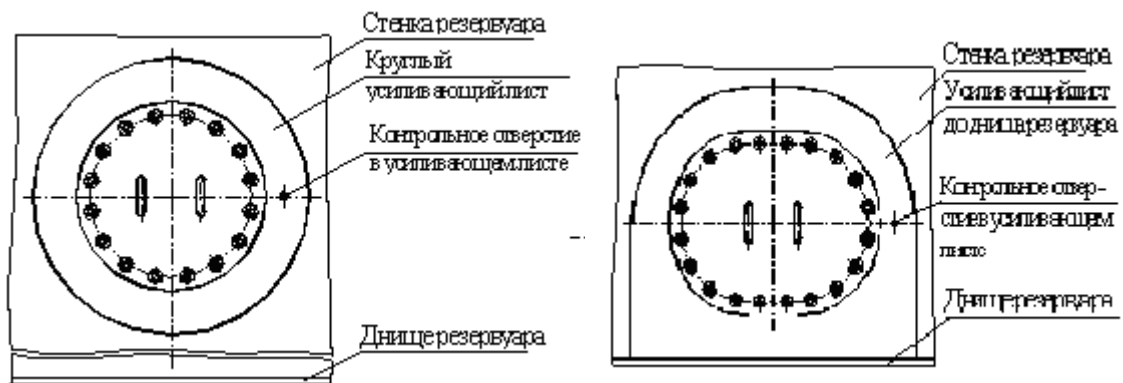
Круглый і овальний люк-лаз в стінці резервуара (фасад)
